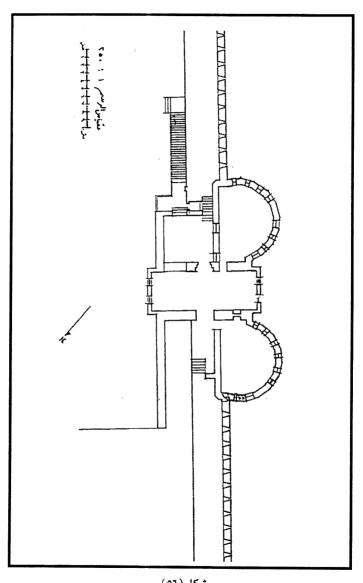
سراى العدل – مسقط أفقى عن حسن عبدالوهاب
